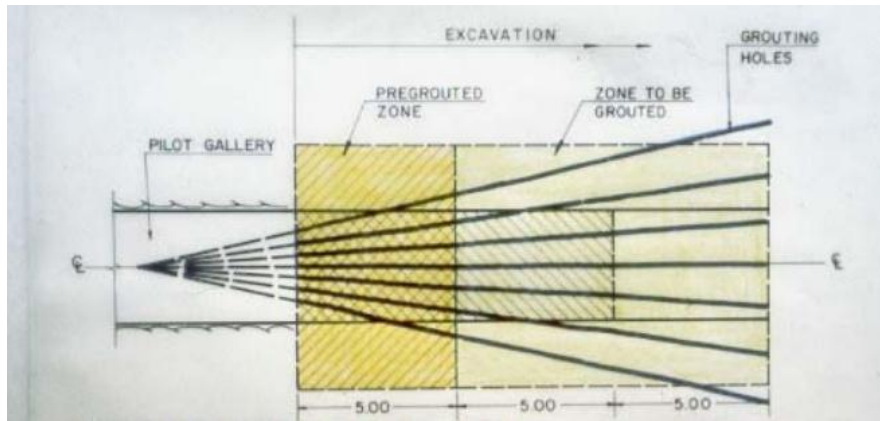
Planta con el esquema de inyecciones desde el frente de excavación de la galería piloto.
